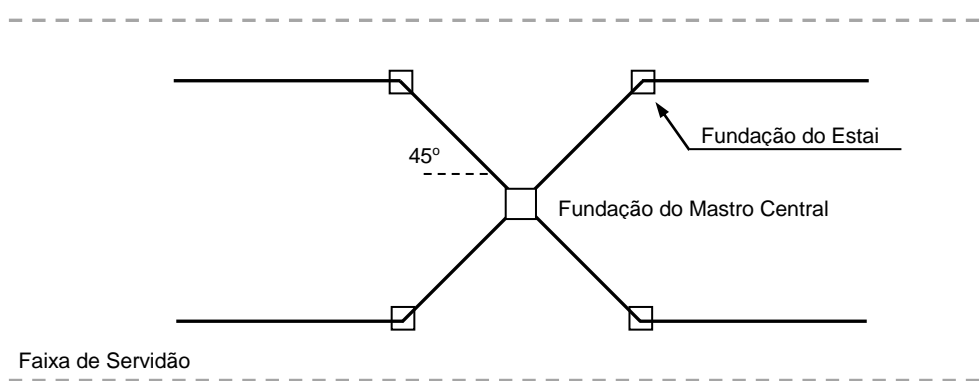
Configuração do aterramento comumente utilizado em estruturas estaiadas.
